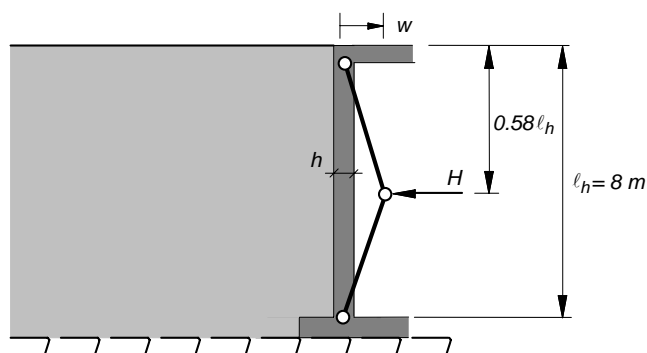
Paroi latérale d'une tranchée couverte de type cadre en stade de construction
